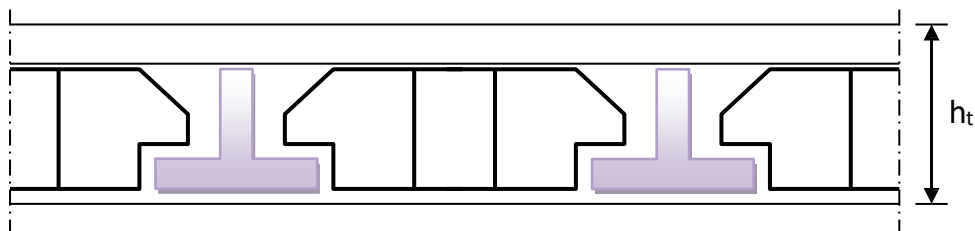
« Coupe transversale d'un plancher à corps creux »
